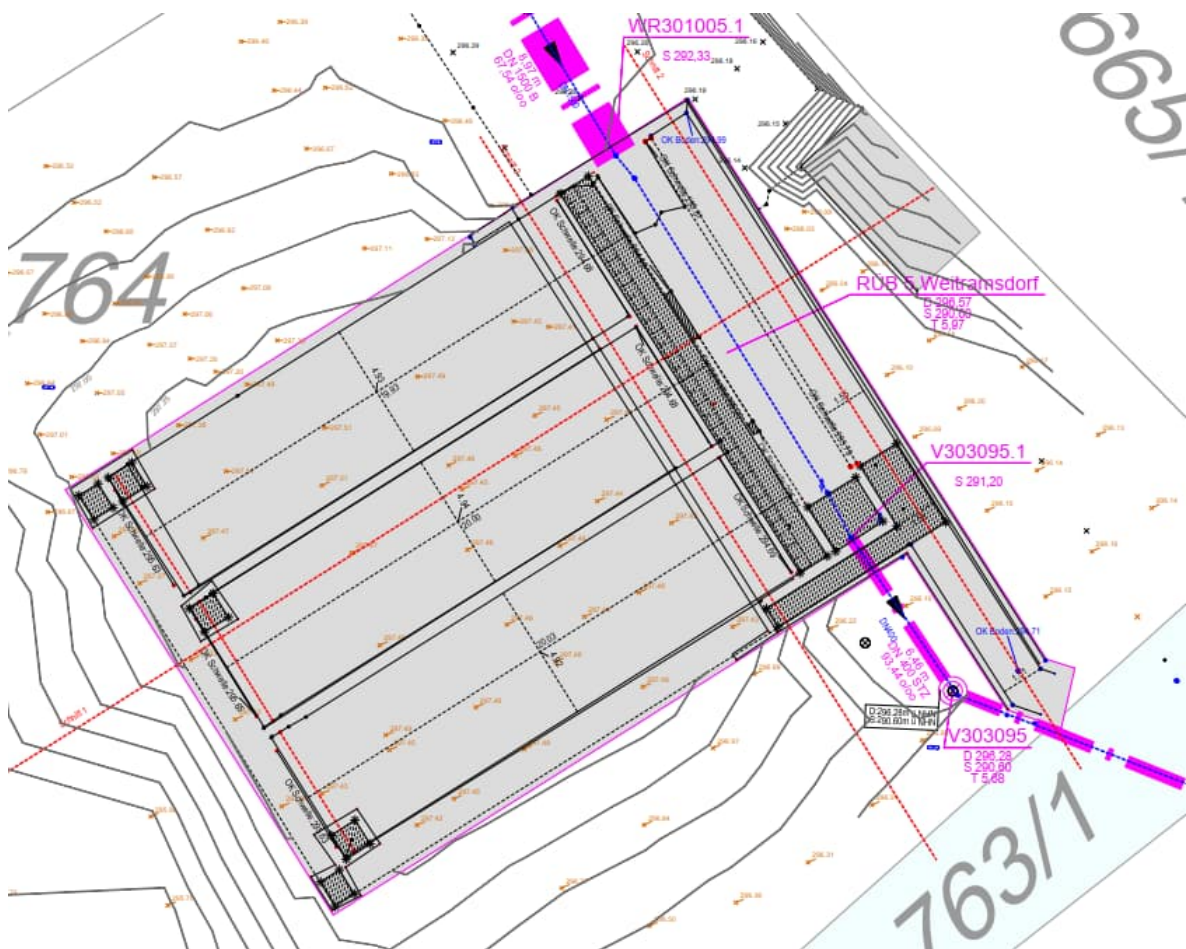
Grundriss RÜB 3 Weitramsdorf
